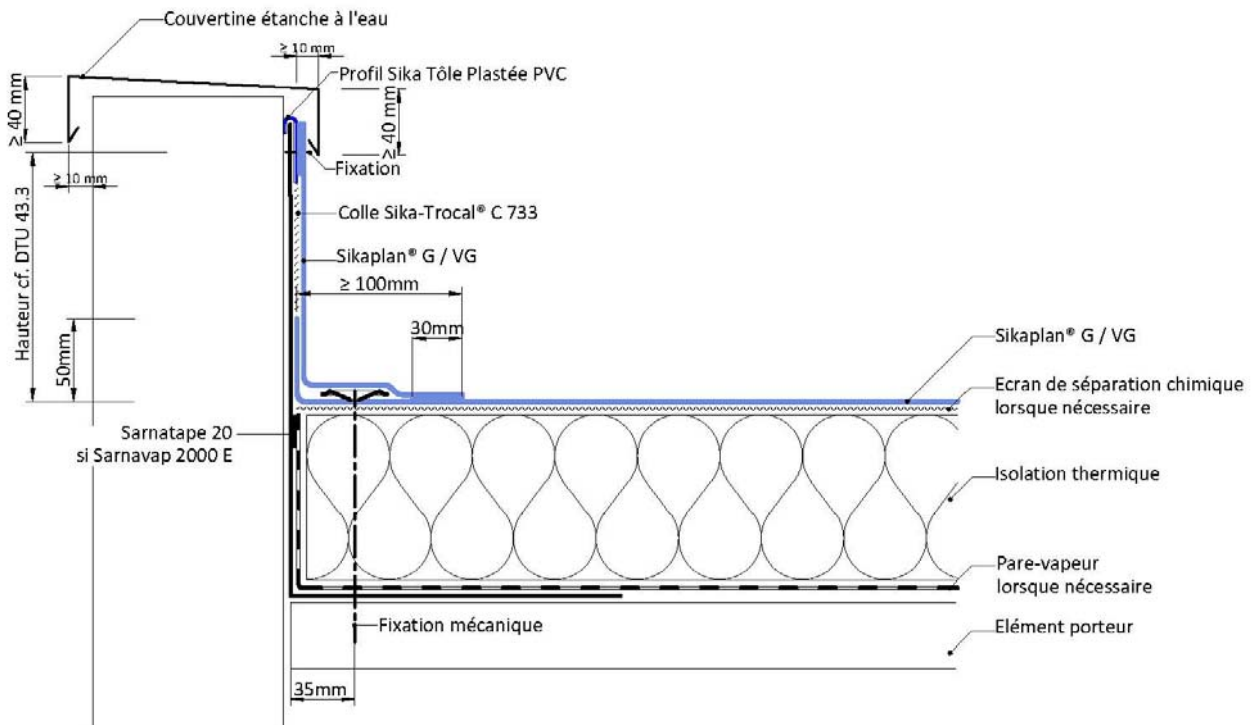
Relevé d'étanchéité sous couverture – Travaux de réfection sur tôle d'acier nervurée
